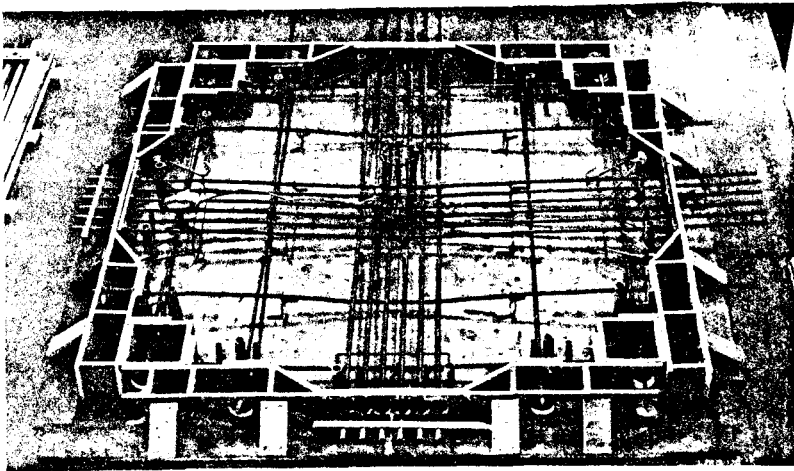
Versuchskörper V4 (ohne Betonstahl) vor dem Betonieren
